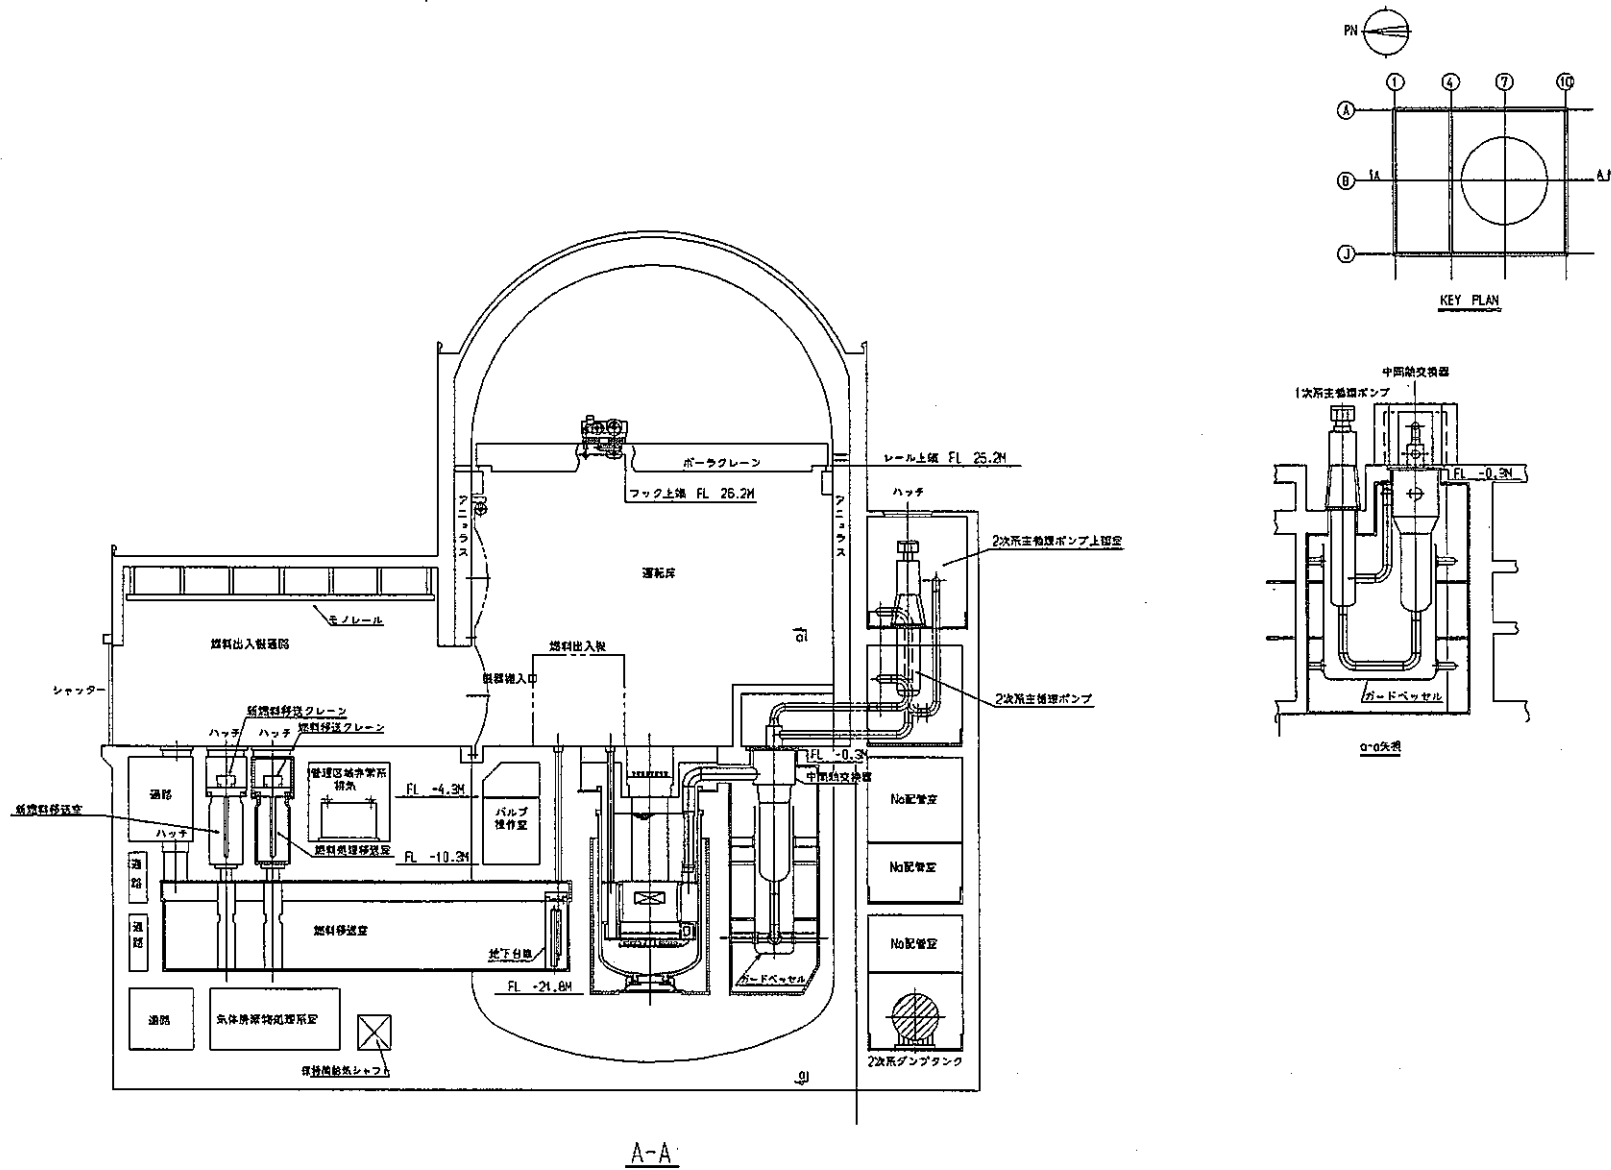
原子炉施設全体機器配置図 (A-A 断面)
